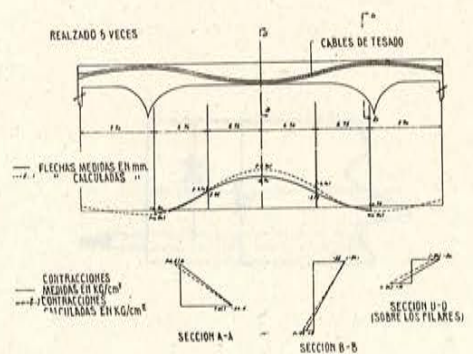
Deformaciones y contracciones producidas por la puesta en marcha del 40 por 100 de la fuerza total de pretensado.
